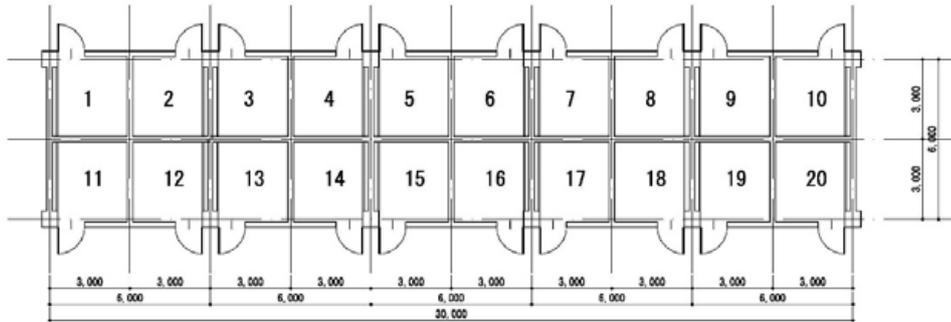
漁民ロッカー 平面図 (1棟当たり)
